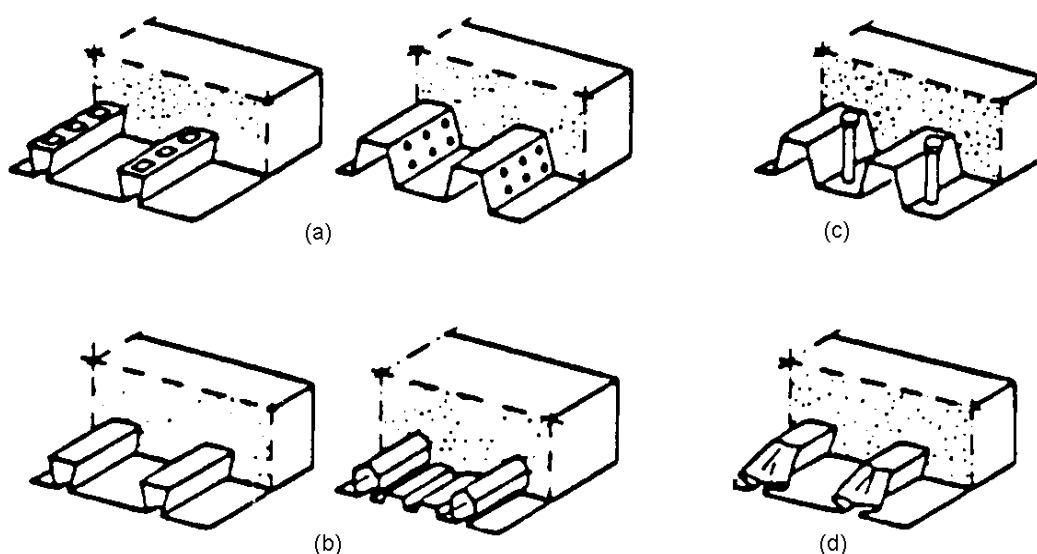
Formas típicas de ligação em lajes mistas
